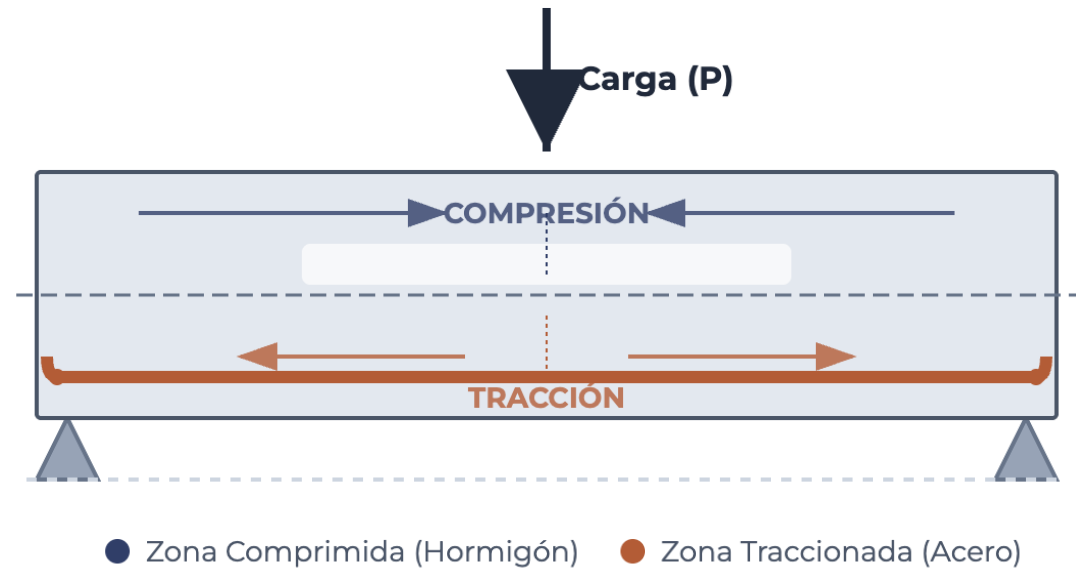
Esquema del comportamiento a flexión de una viga biapoyada de hormigón armado. Elaboración propia
